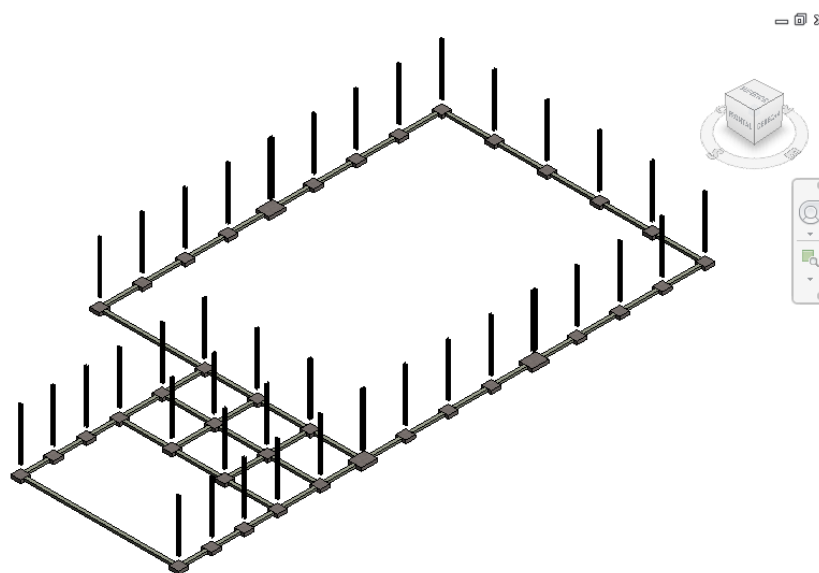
Modelo con vigas de atado dispuestas. Fuente: elaboración propia
